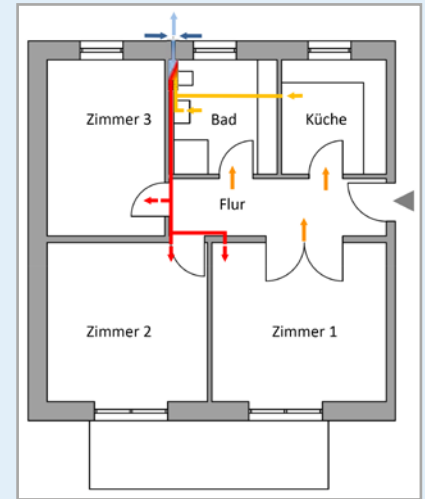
Darstellung des Lüftungskonzepts im Grundriss mit Einbausituation über dem WC
